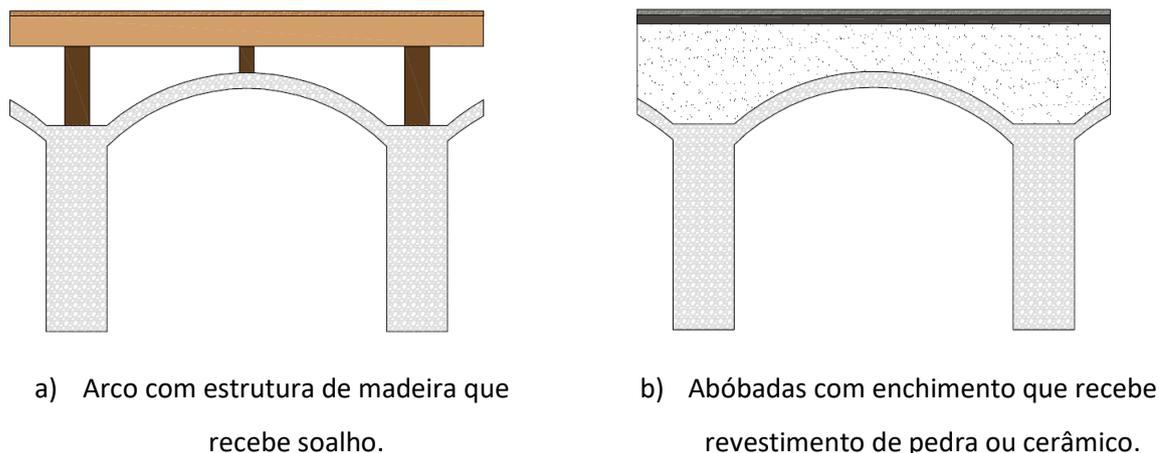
Estrutura de pavimento constituída por arco e abóbada de alvenaria.
